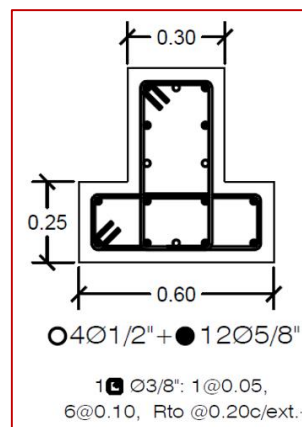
Disposición de Acero Longitudinal y Transversal de la Columna TEE Ubicada en la Intersección de los ejes A y 2.
